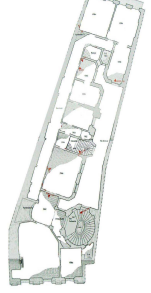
Botter Apartmanı Çatı Katı Planı
